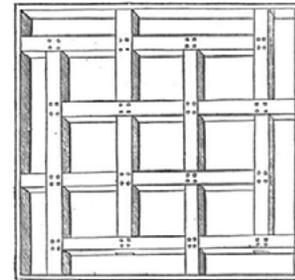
sistema para hacer forjados de madera cuando las vigas de las que dispone son de menor dimensión que la luz del espacio a cubrir (Serlio, 1551).
